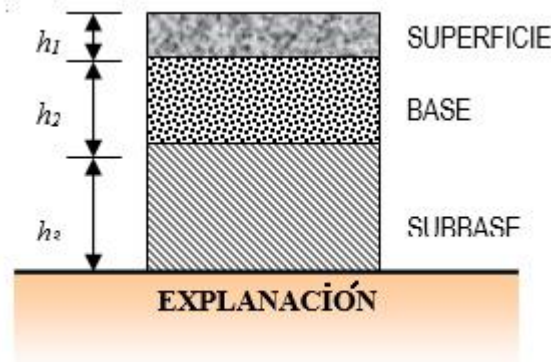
Estructura del pavimento flexible. Fuente: Elaboración propia
